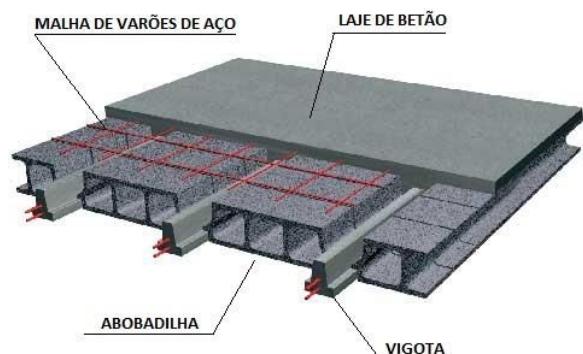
Figura SEQ Figura V* ARABIC 13 PAVIMENTO ALIGEIRADO
